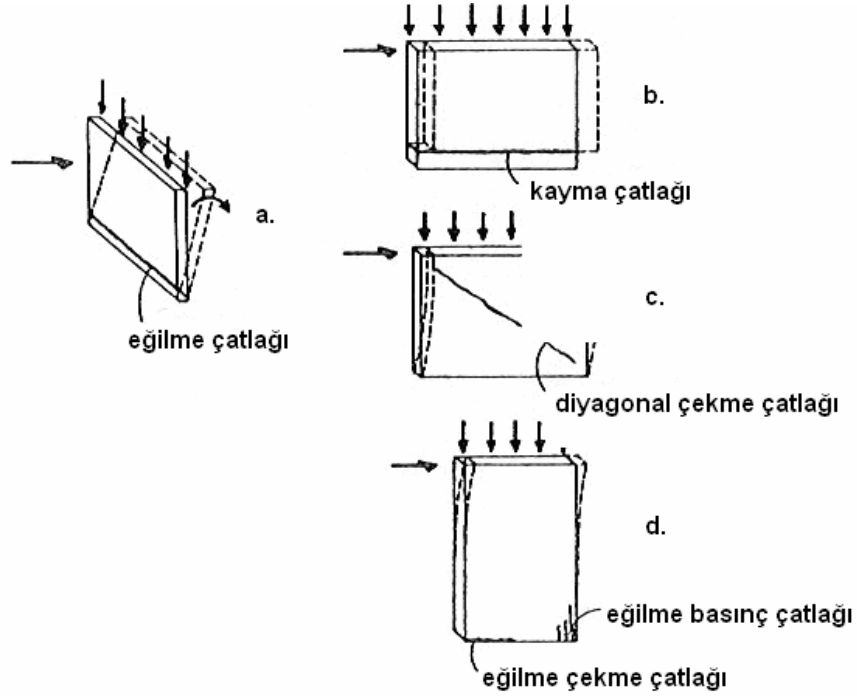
Kayma kırılmasının mekanizması [8].
